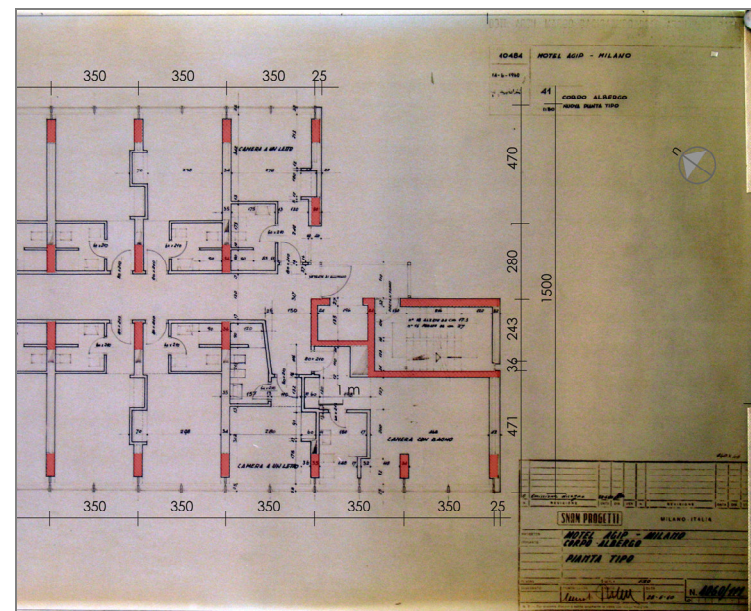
piano tipo corpo albergo: elementi strutturali in cemento armato (fonte CSAC – stralcio tav. 41, archivio n. 181-2, rielaborazione f.m.)
